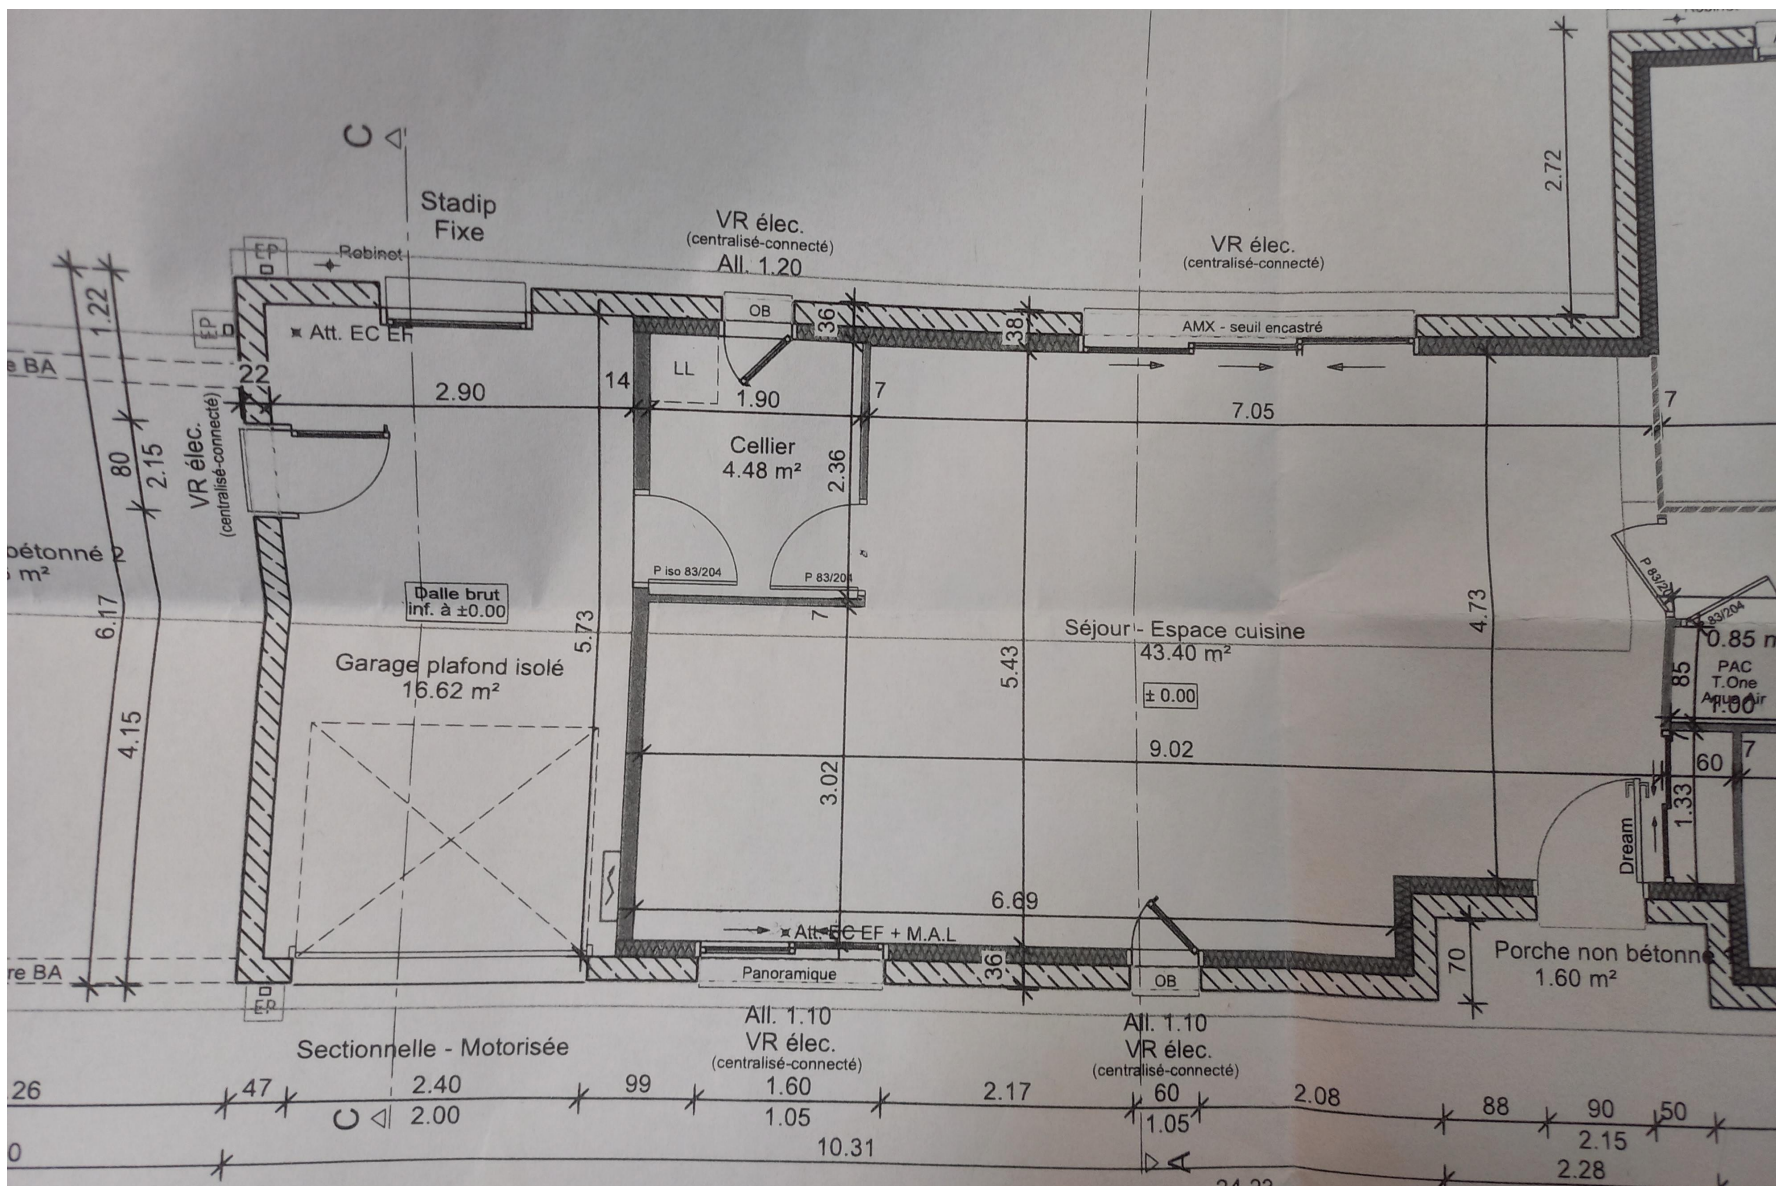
PHOTO DU PLAN MASSE DU CONSTRUCTEUR
